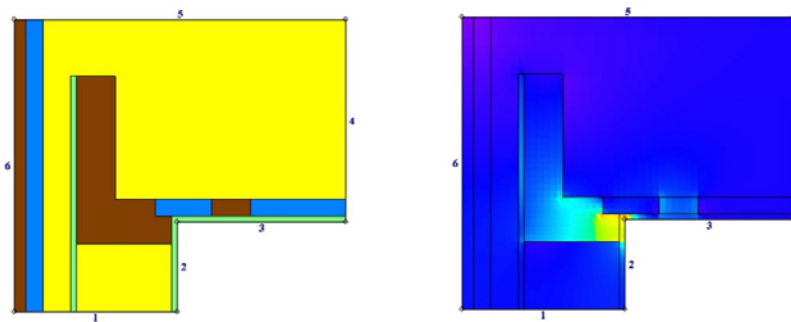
Konstruktion och värmeflöden för detaljen "Anslutning yttervägg/grund" i Villan - grundfallet. Figuren visar anslutningen mellan yttervägg och bottenbjälklag.
